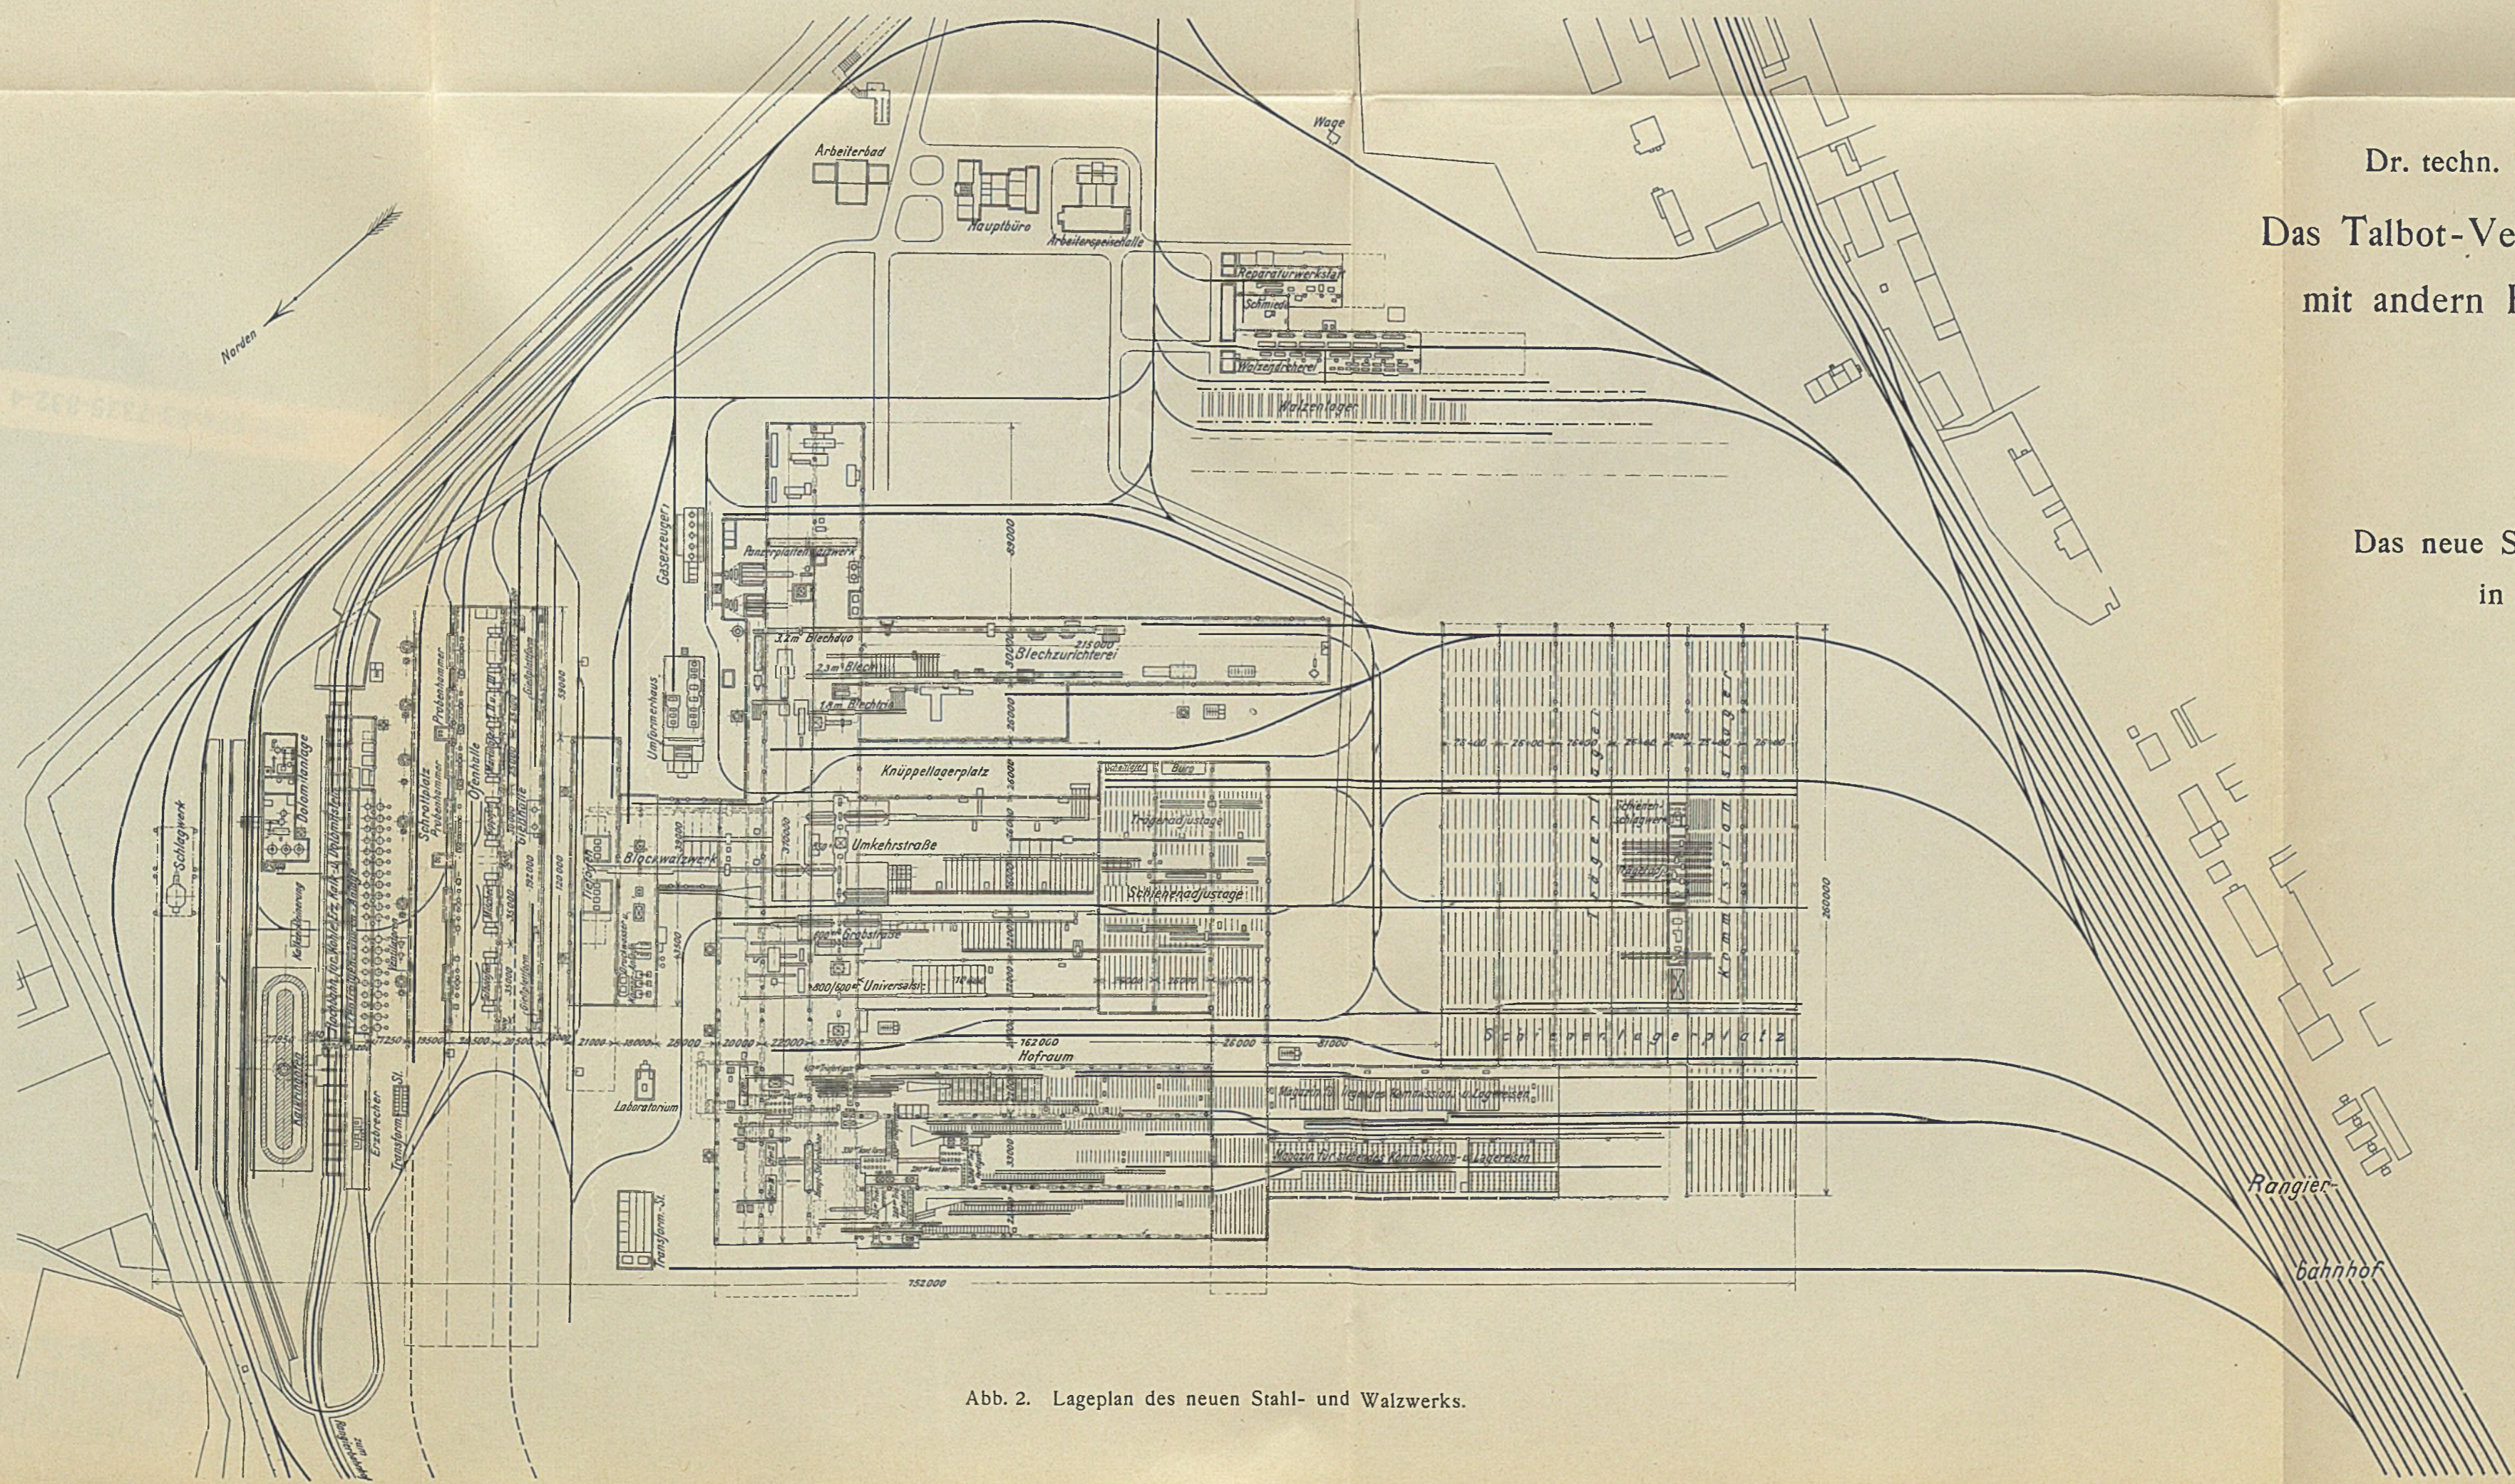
Lageplan des neuen Stahl- und Walzwerks.
